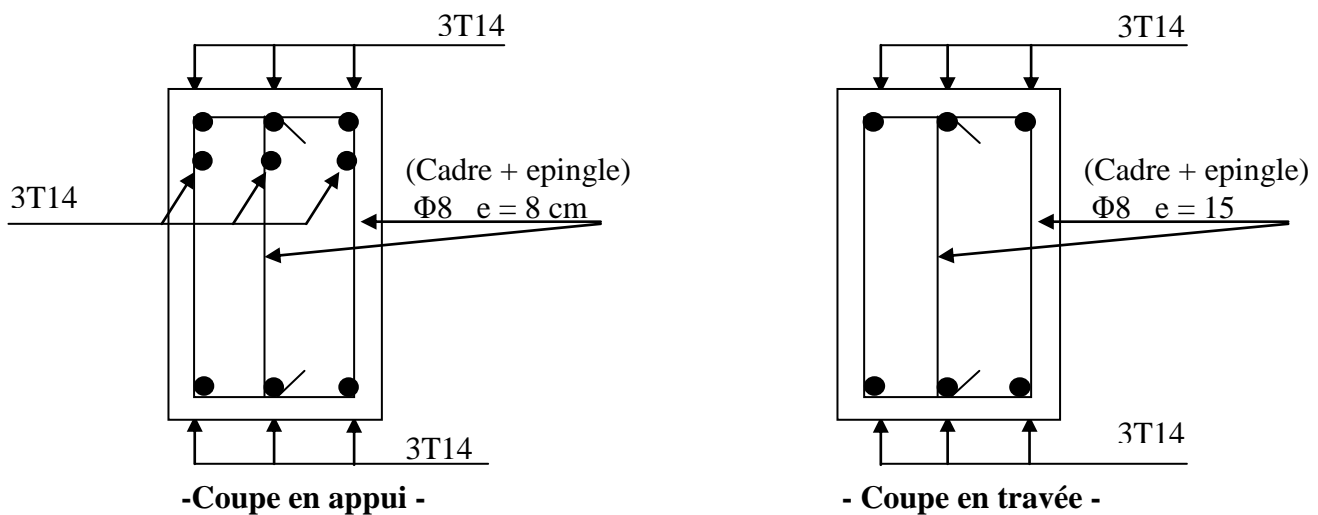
Schéma de ferrailage pour la poutre principale en travée et en appuis
